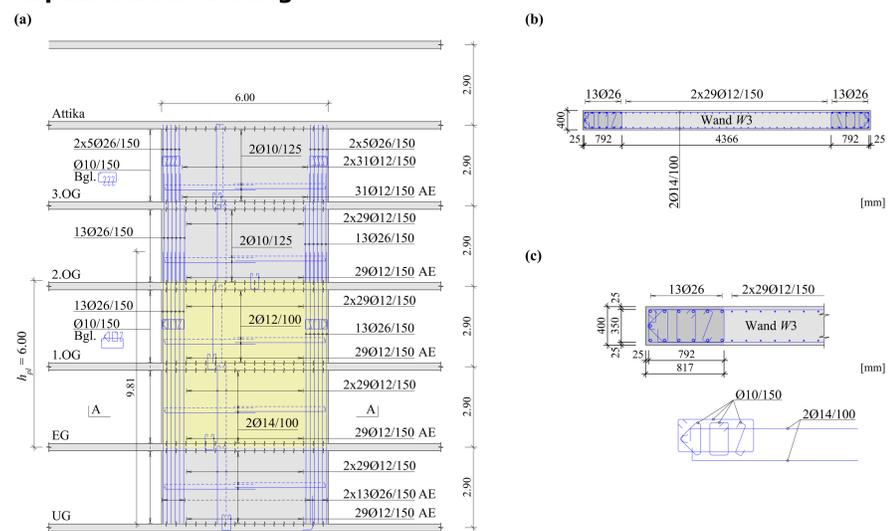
Konstruktive Durchbildung: (a) Ansicht; (b) Schnitt A - A; (c) Detailschnitt.
